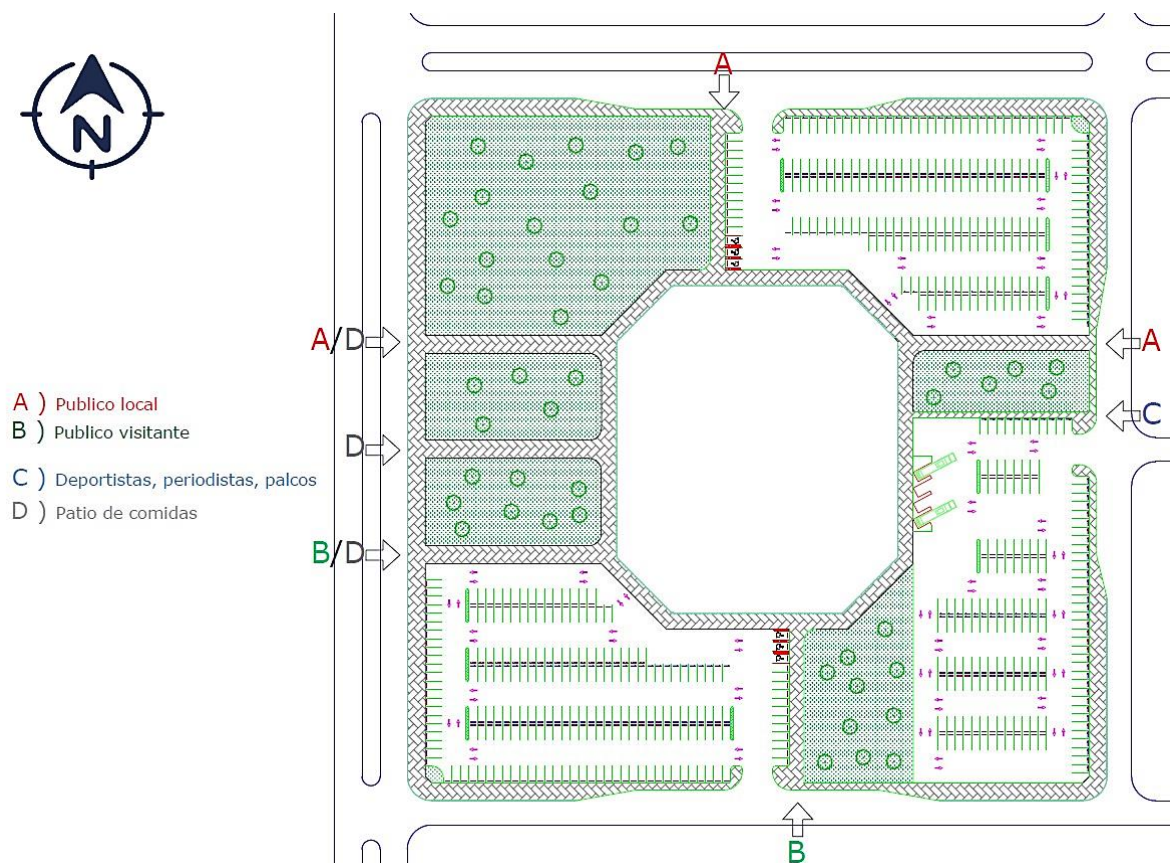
Vista en planta de los accesos peatonales al predio. Fuente: elaboración propia.
